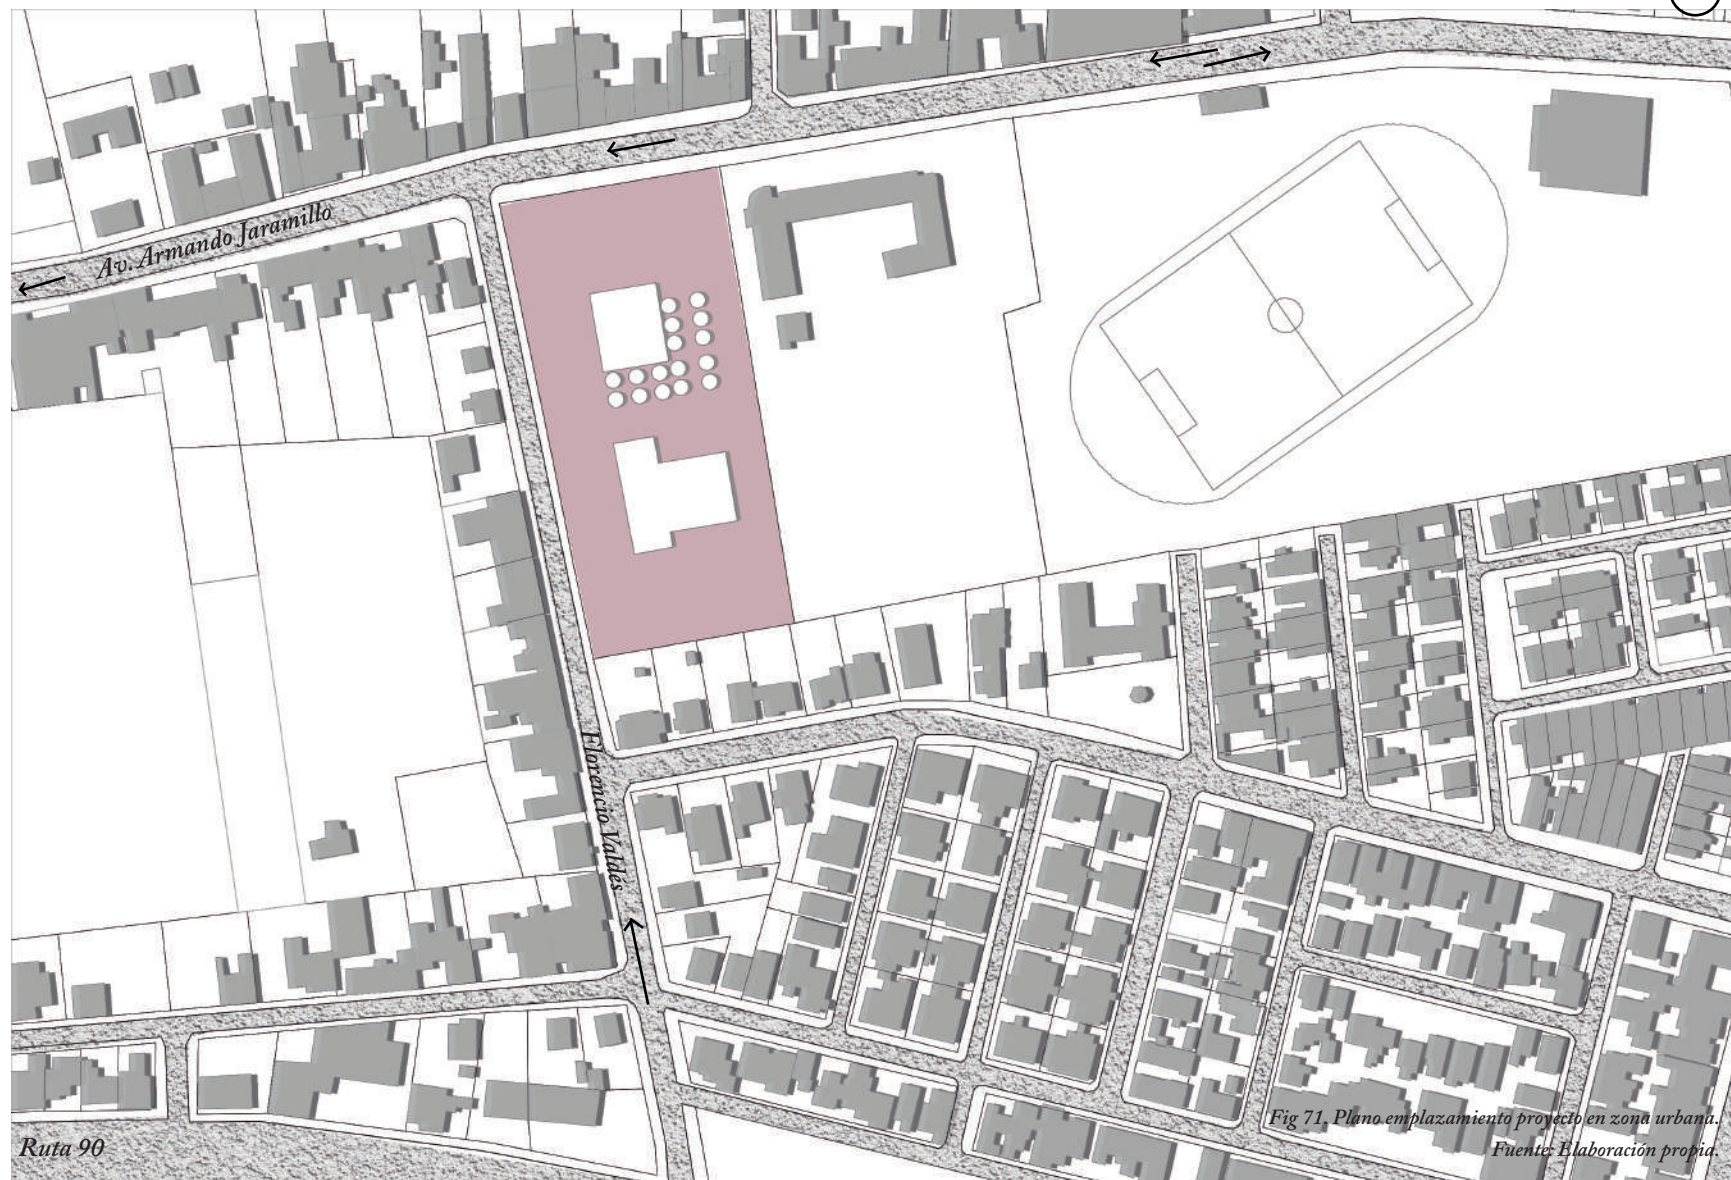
Plano emplazamiento proyecto en zona urbana.
